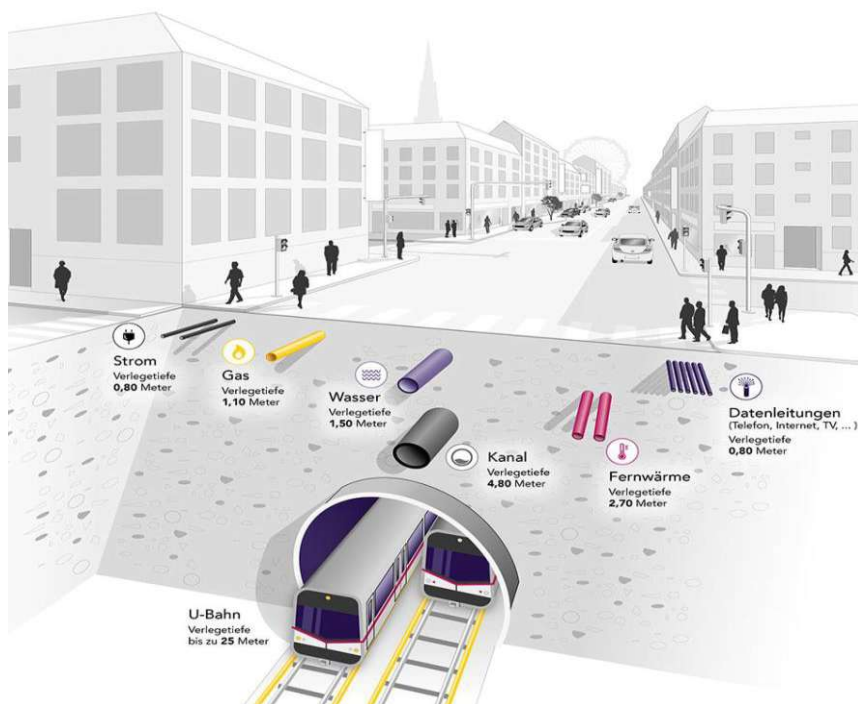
Einbauten Schnitt Untergrund (© Wiener Netze GmbH)
